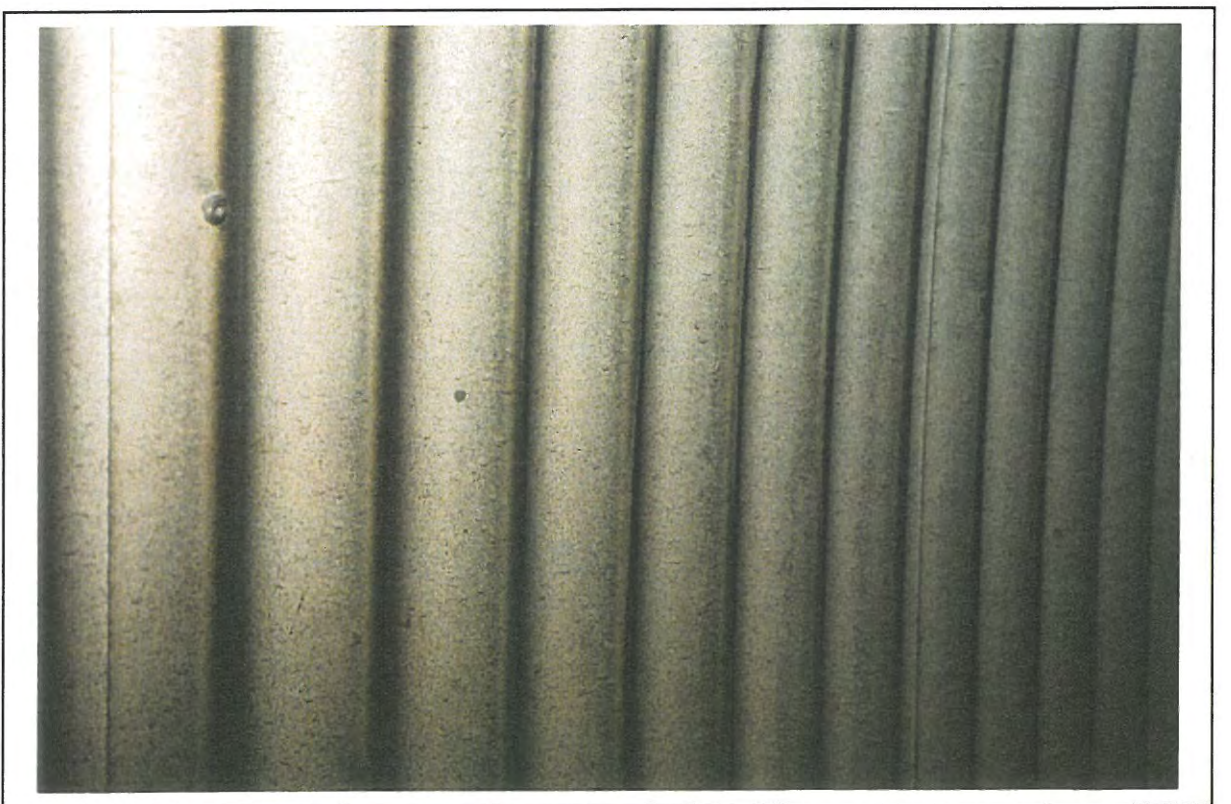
Holmestrandtunnelen 1/4 97: Plasstøpt betonghvelv med oppsprekking og kalkutfelling.
